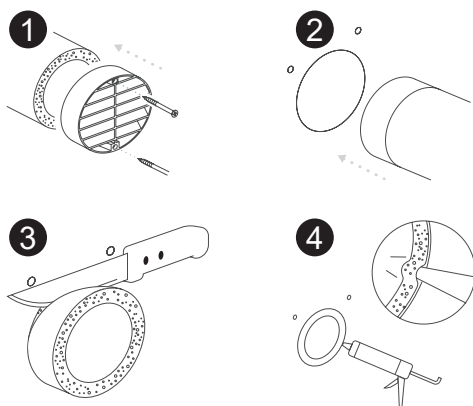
Установка теплоизоляционной трубы с вентиляционной решеткой в канал
